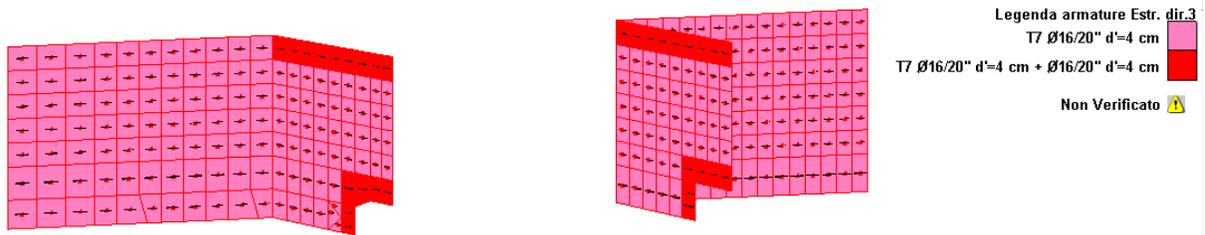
Armatura fusto Spalla di Estradosso ed Intradosso direzione 2
